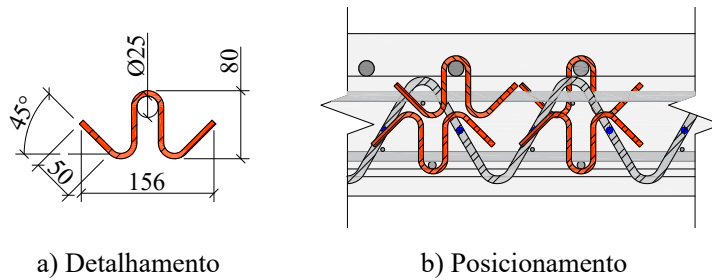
Detalhe da armadura de cisalhamento das lajes SW1, SW2 e SW3.
